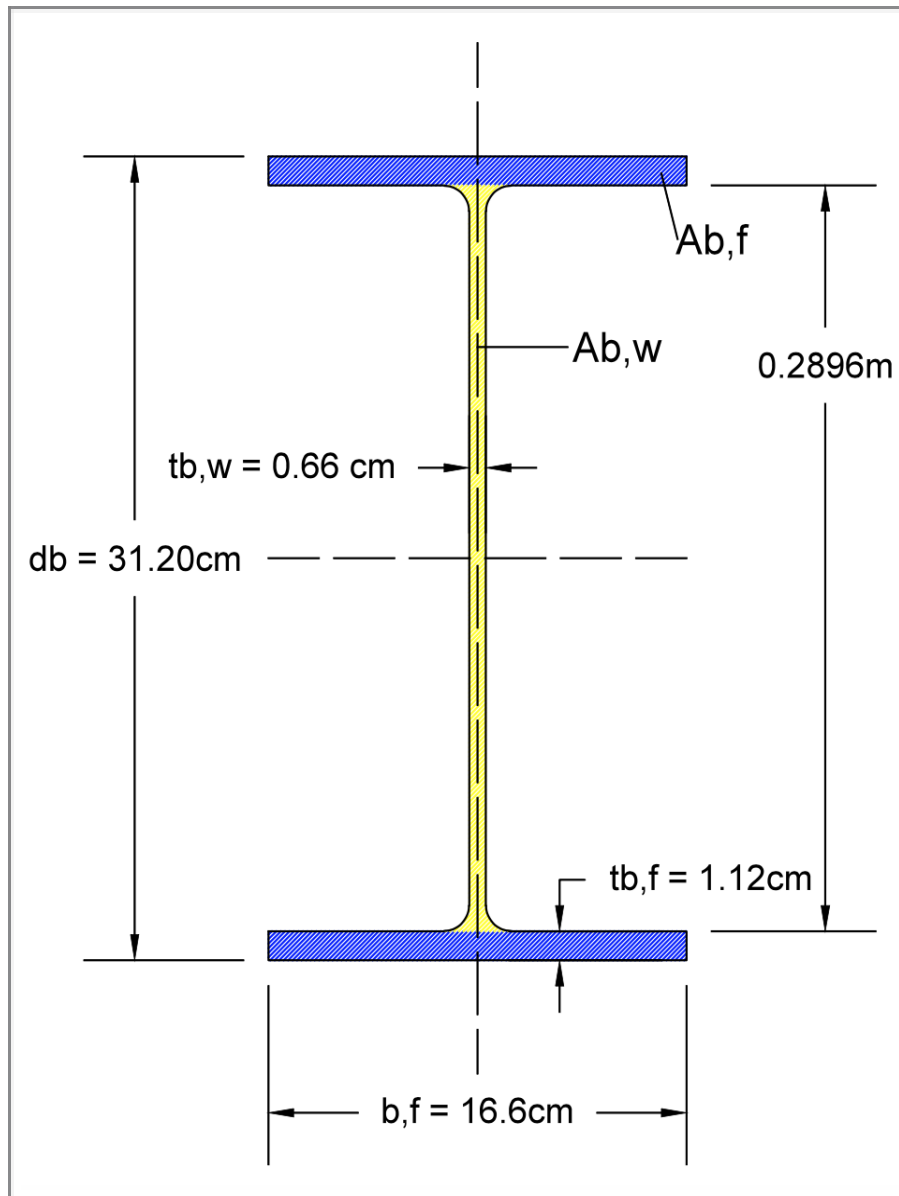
Sección transversal de la viga. (Elaborado por el autor, 2017)
